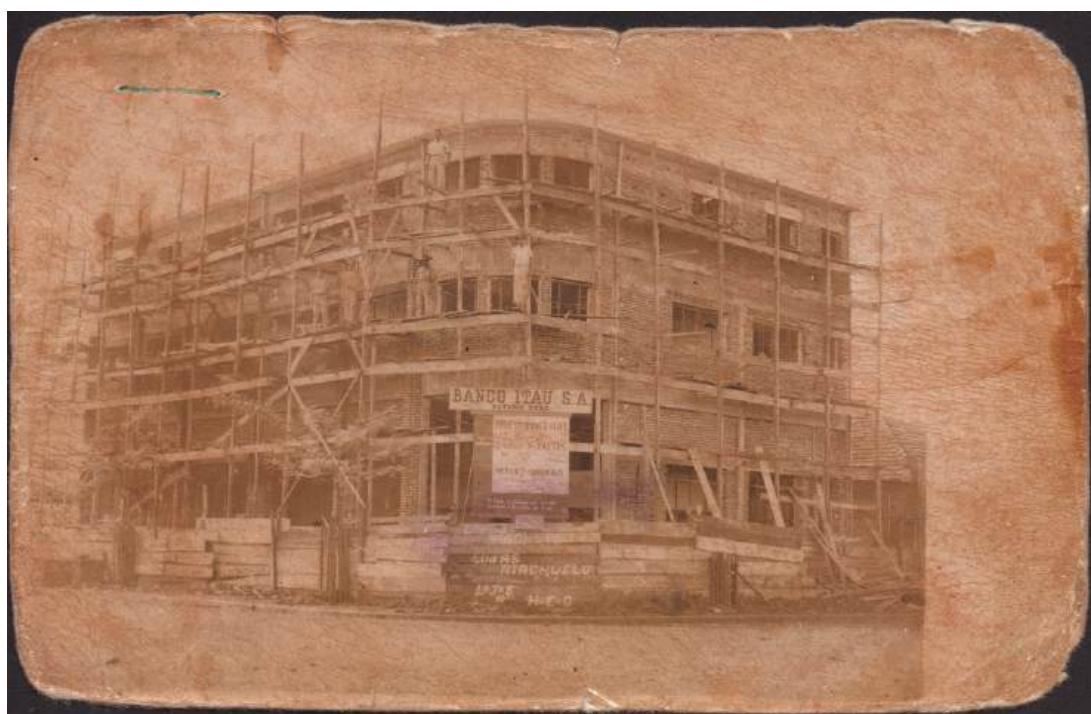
Imagem da construção do Banco Noroeste, em Marialva/PR.
